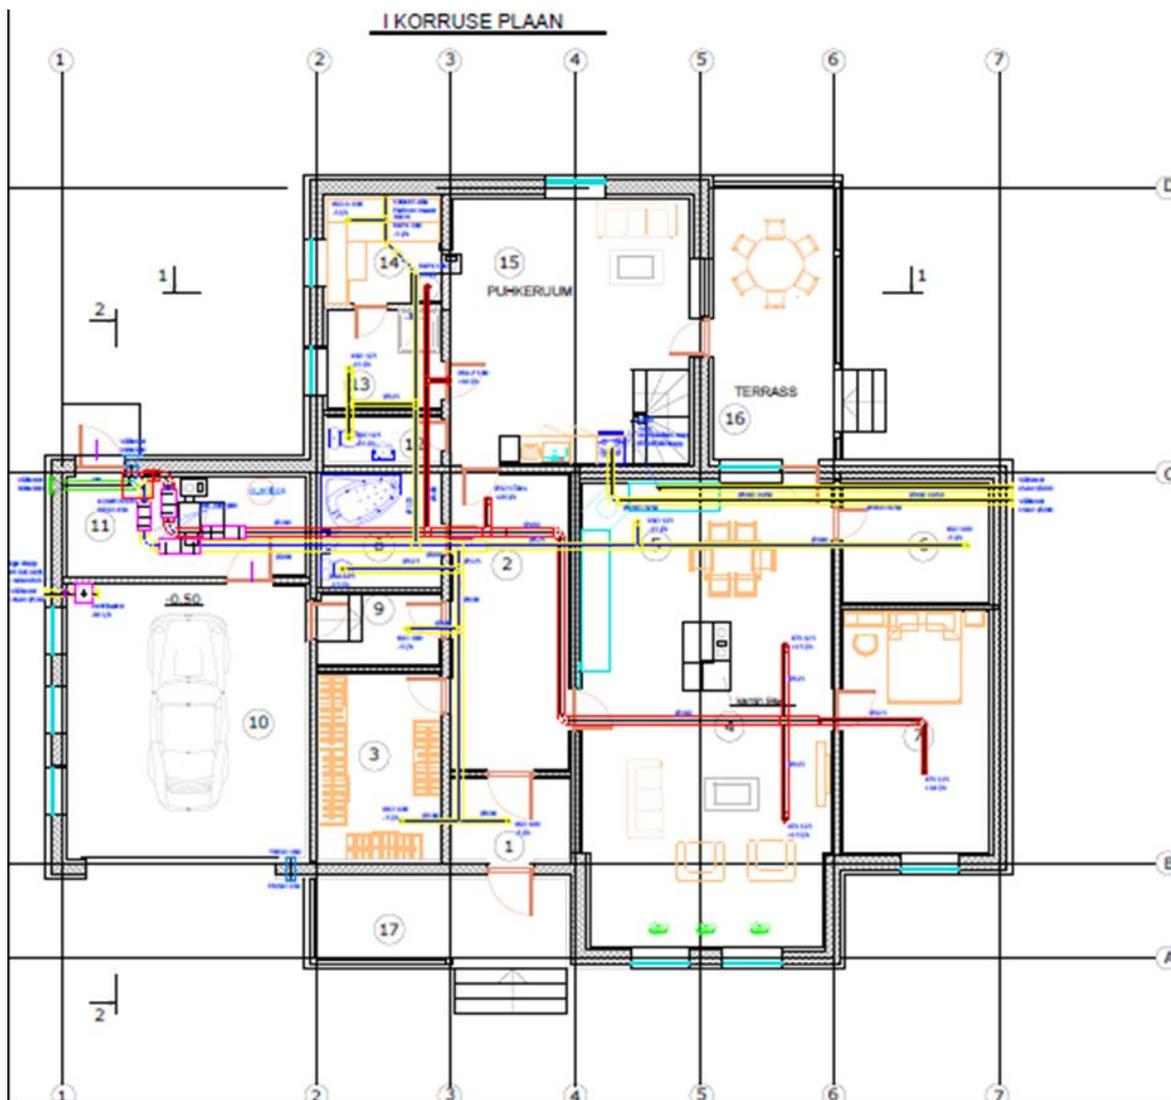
Схема прокладки воздуховодов приточно-вытяжной вентиляции на первом этаже дома
